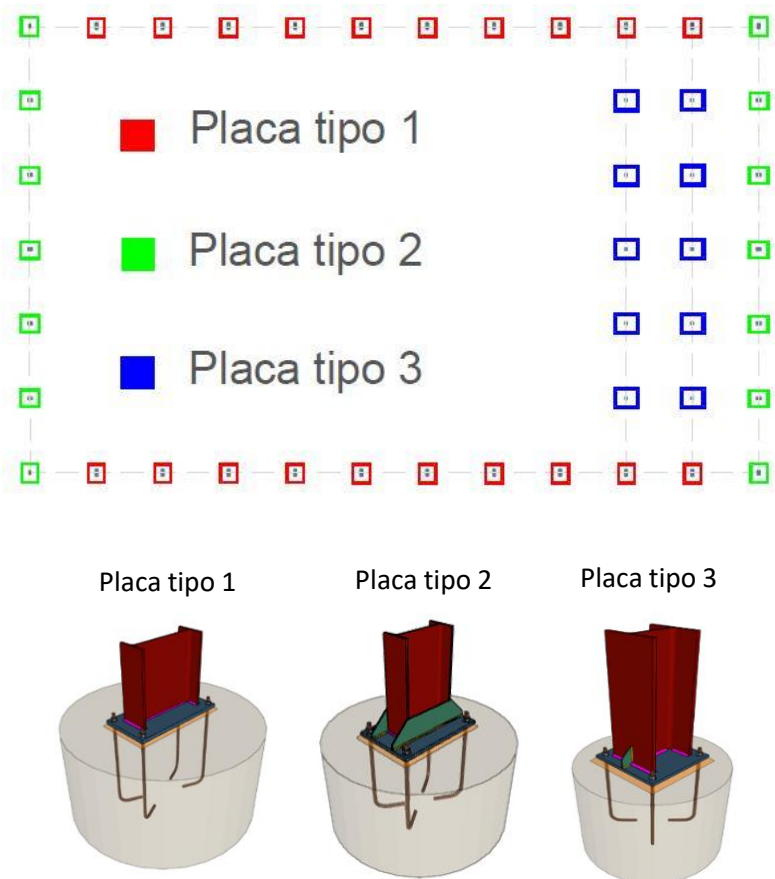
Tipologías de placa de anclaje. (Fuente propia y CYPE)
